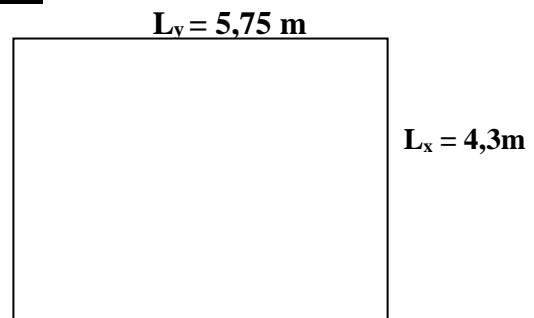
La section de plus grand Panneau de la dalle pleine de sous-sol (parking).
